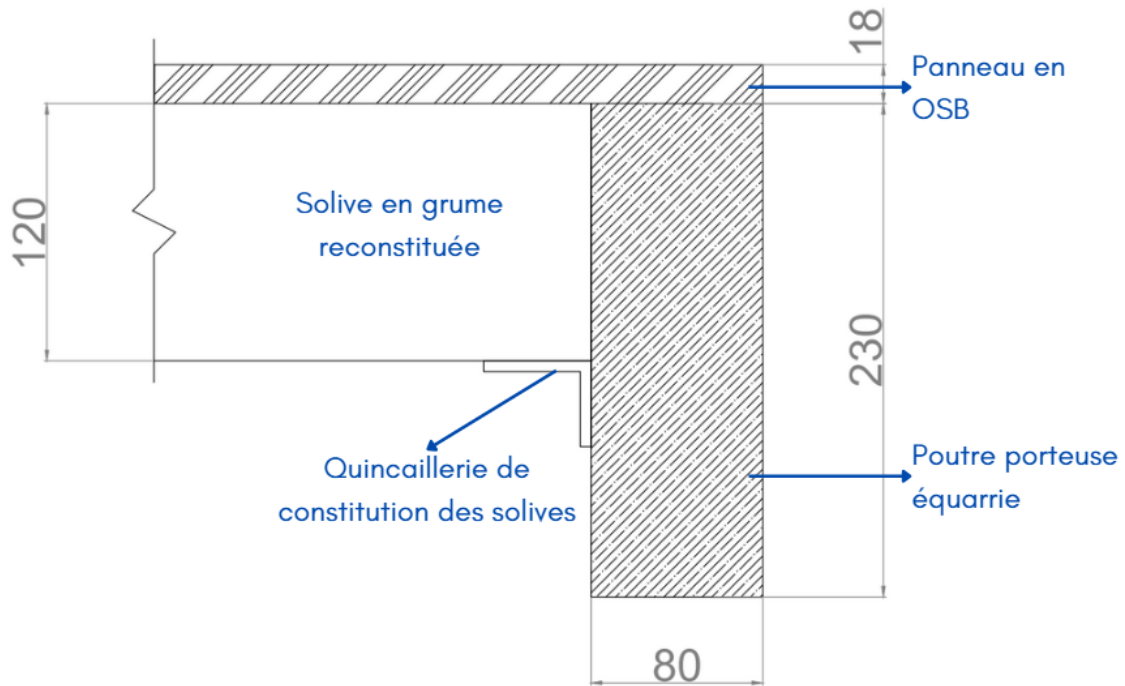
Vue en coupe longitudinale du plancher (extrémité).
